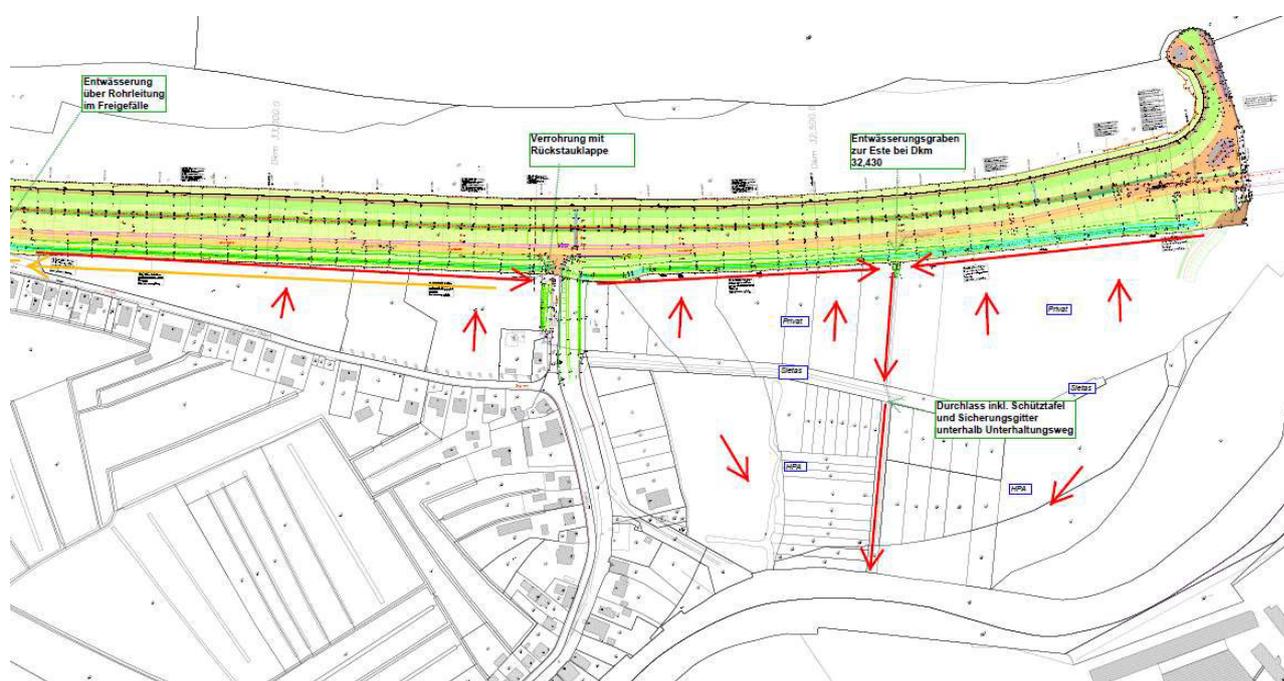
Ausschnitt Cranzer Hauptdeichs (Strecke) mit Darstellung der Entwässerungssituation
